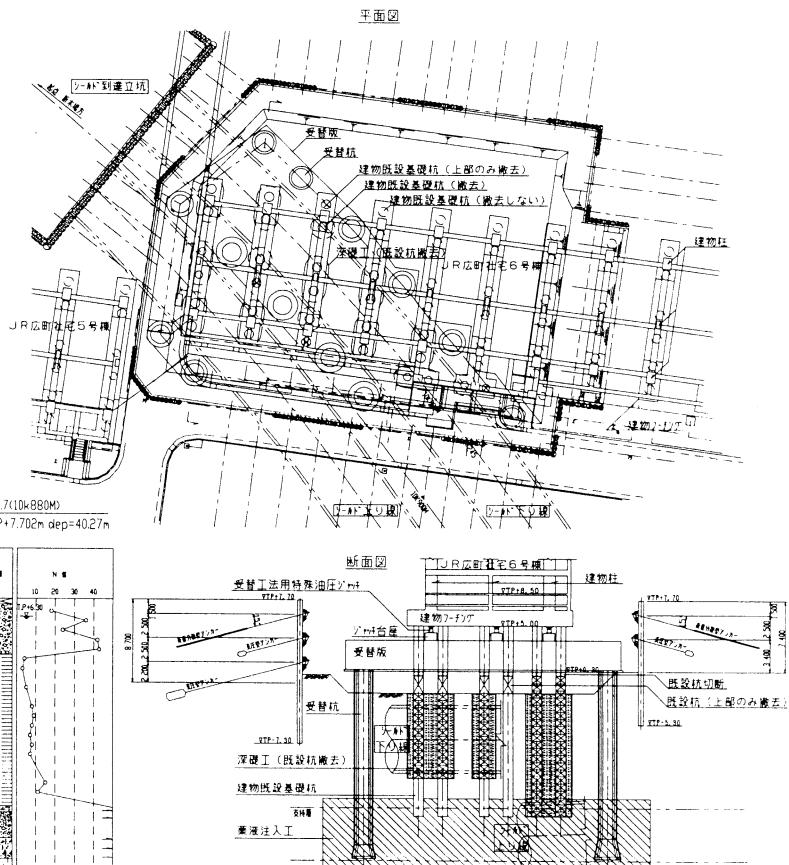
JR広町社宅6号棟アンダーピニング施工概要図
